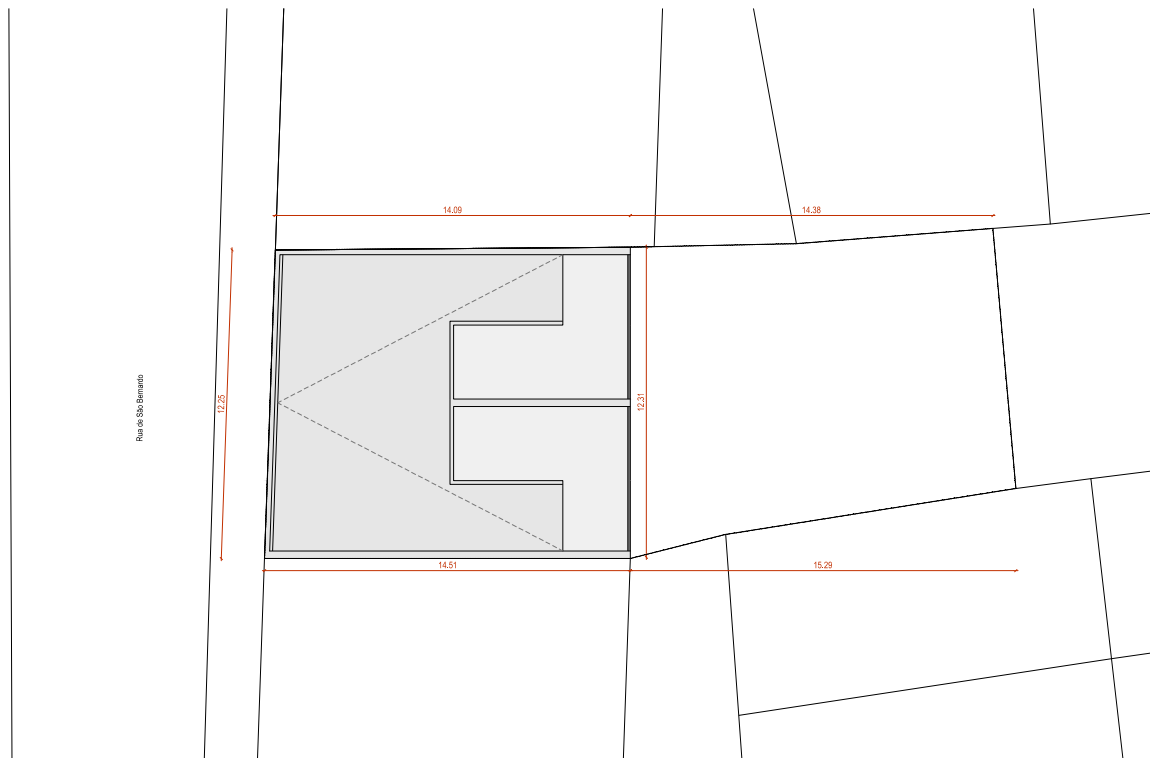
Proposta da Planta de Implantação (Fonte: Autor)
